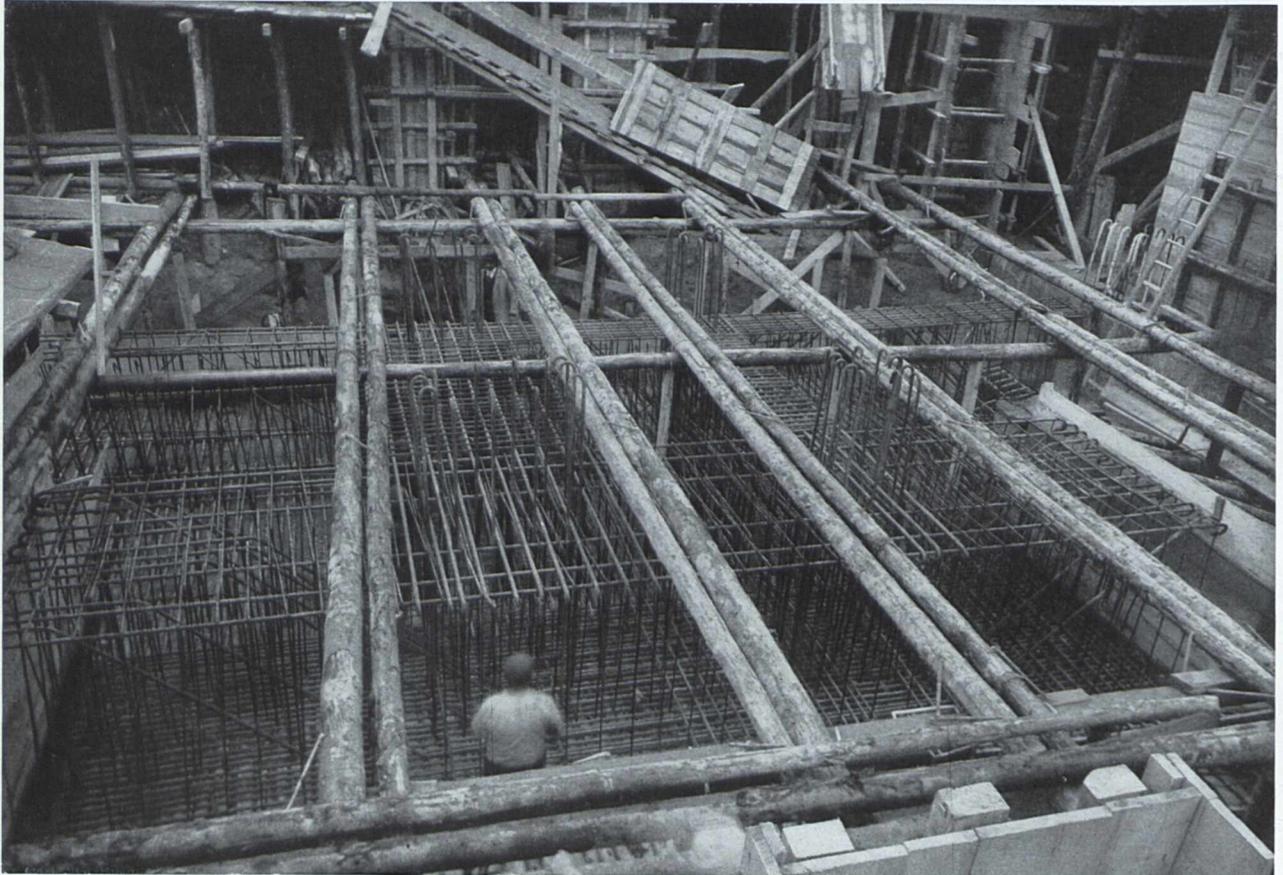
Bauausführung: Karl Stöhr, Bauunternehmung, München, Schwanthalerstraße 11
